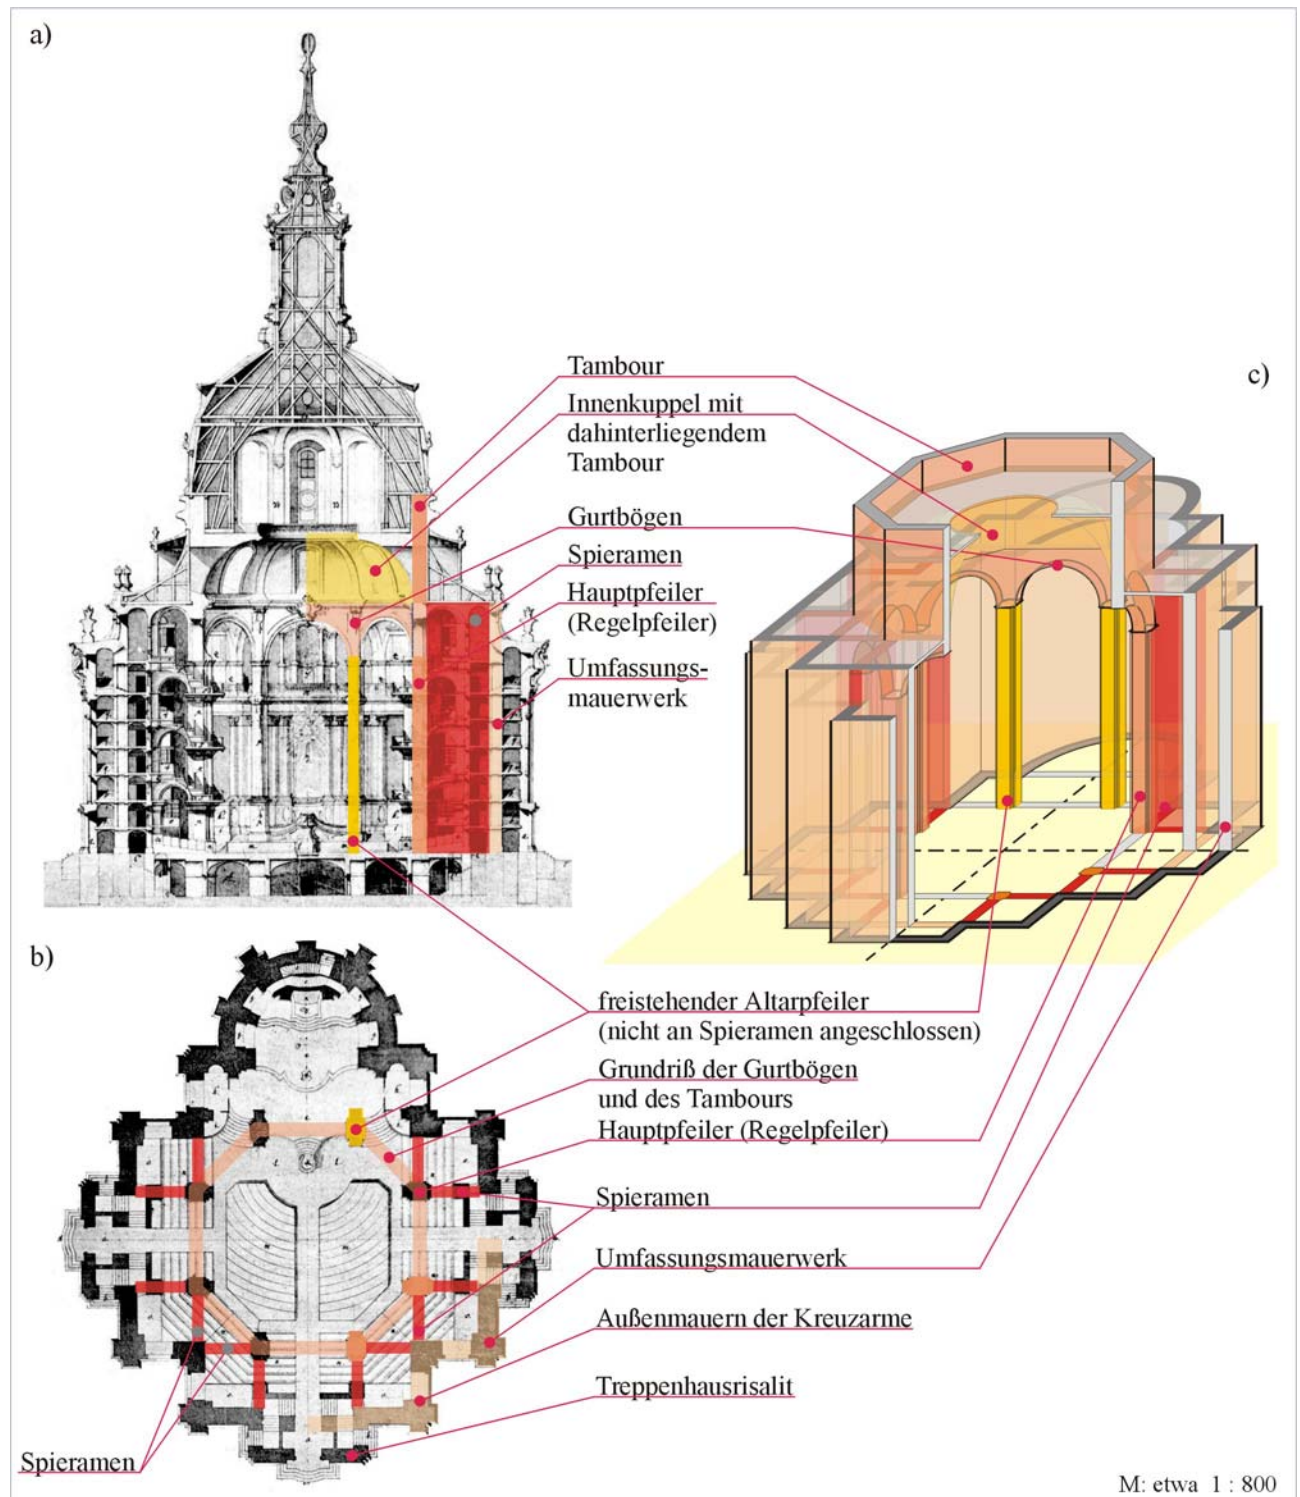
Der Mauerwerkskörper des Ersten Projektes zur Frauenkirche und seine baukonstruktiven Bestandteile.
